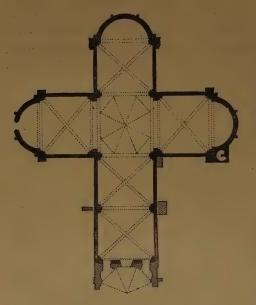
Plan de Saint-Nazaire, à Milan.
